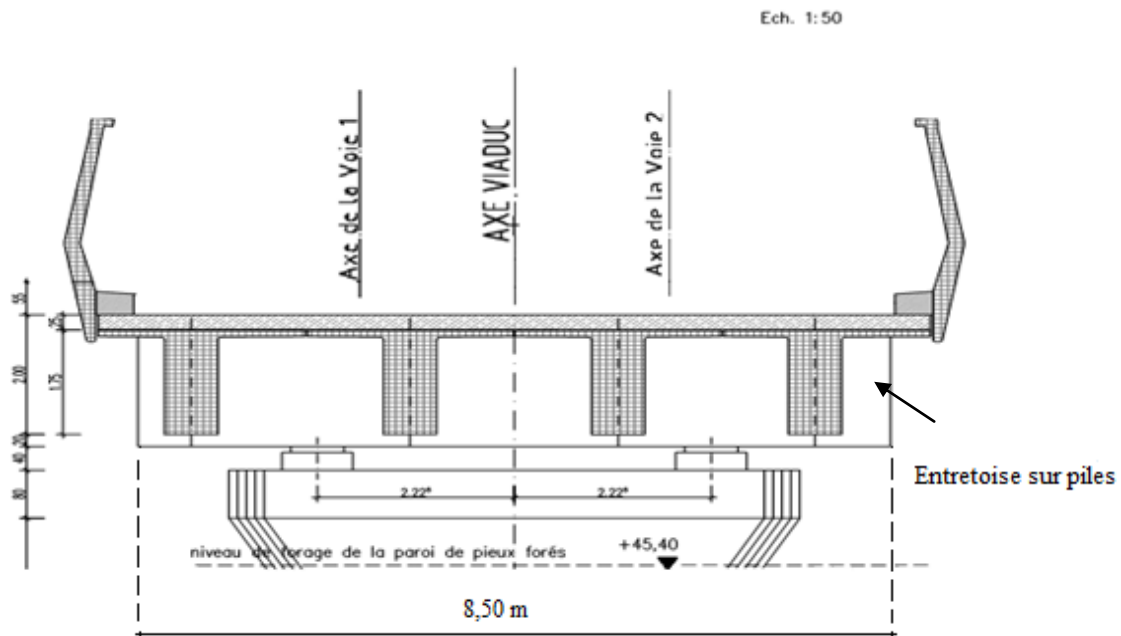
Coupe transversale de l'entretoise sur pile.
